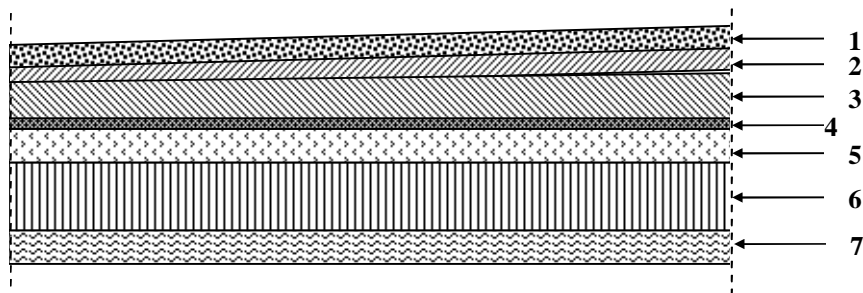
Coupe du plancher de la terrasse inaccessible
